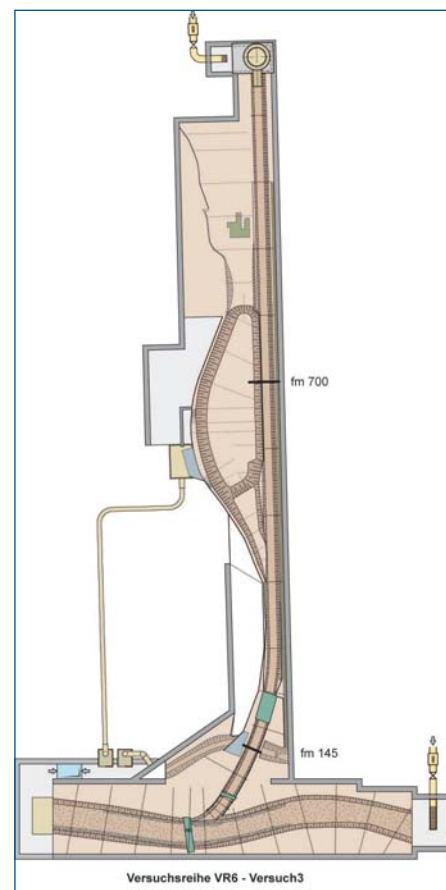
Grundriss der Versuchsanlage HWS «Urner Talboden» (Quelle: VAW).
